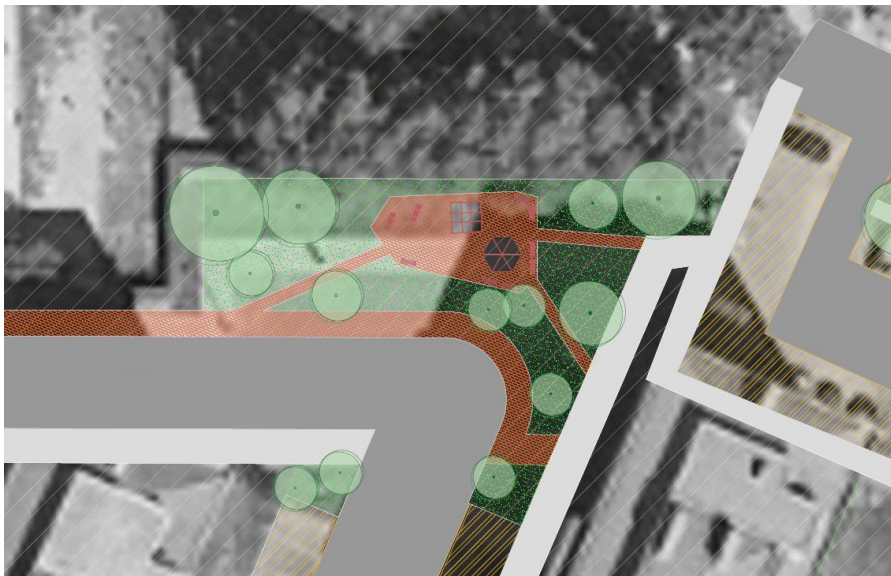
Detalhe proposta praça final da Rua Adelina Caravana
